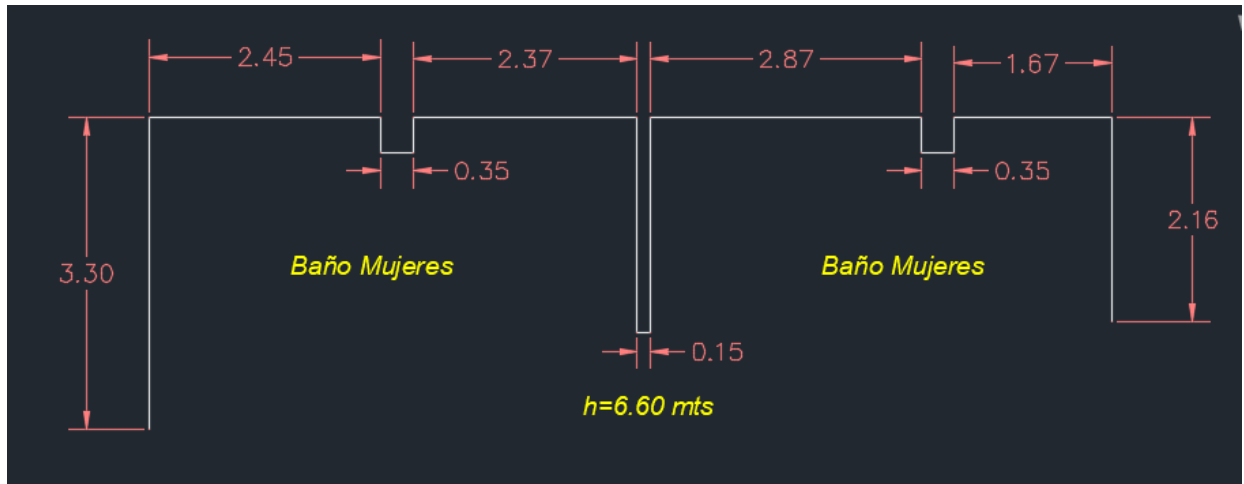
LEVANTAMIENTO DE PAREDES PARA CALCULAR EL ENCHAPE DE PARED.
